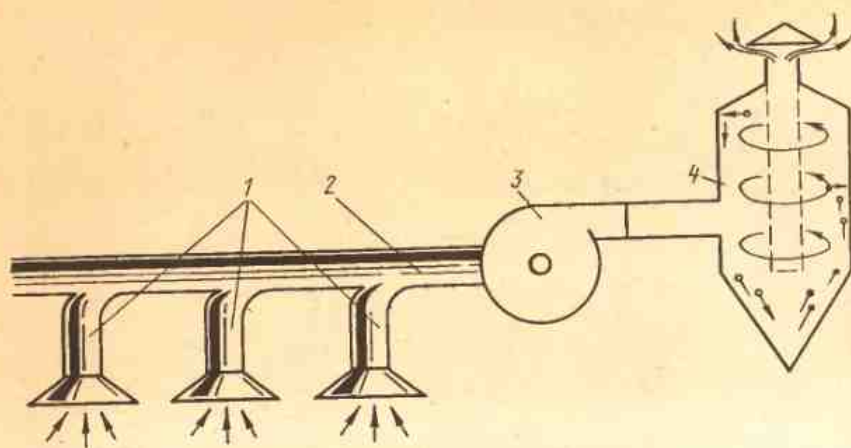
Принципиальная схема вытяжной вентиляции с очисткой воздуха от пыли:
